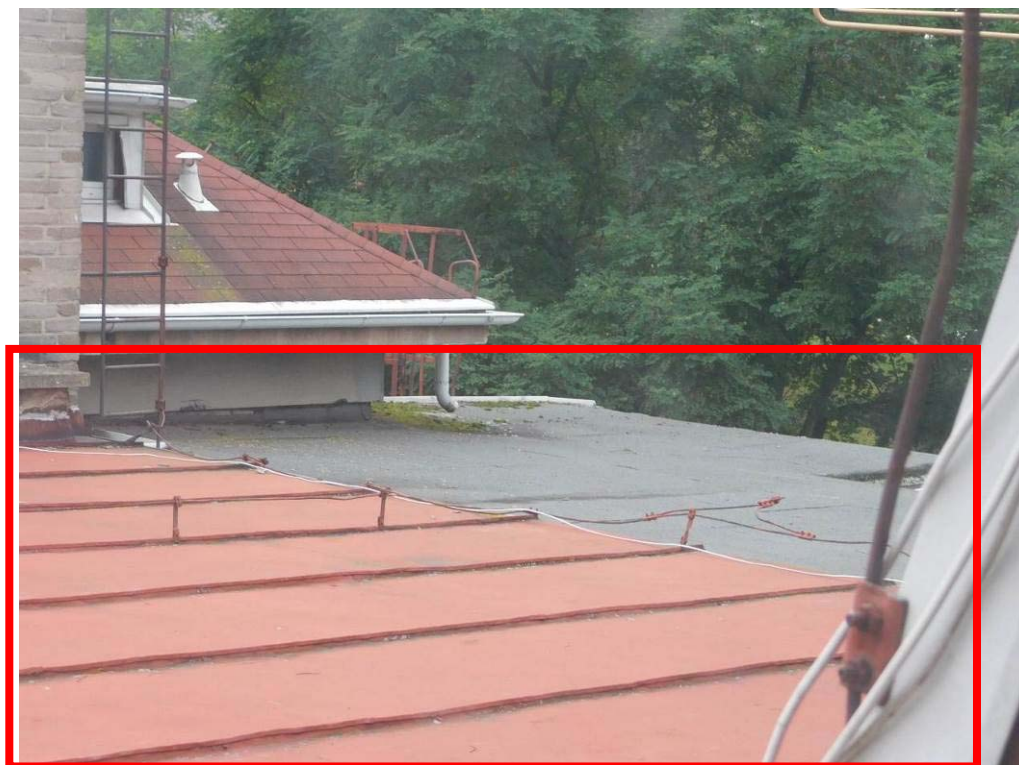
Celkový pohled na střední část objektu – vyznačena sledovaná část krovu
